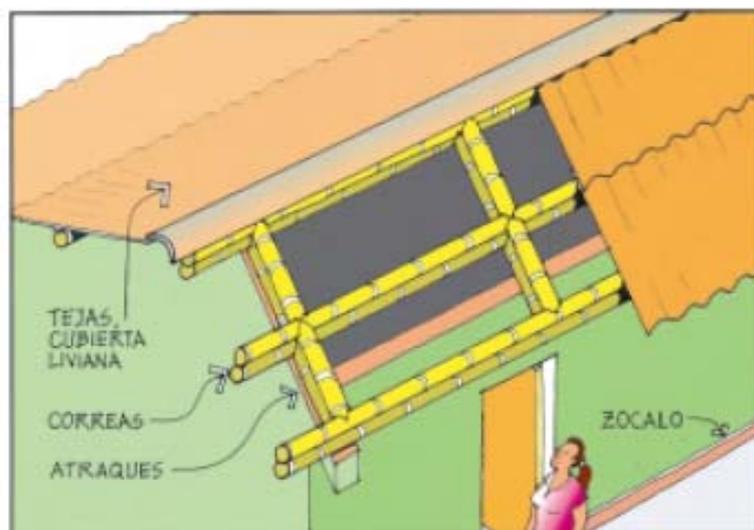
Detalle cubierta. Fuente AIS
